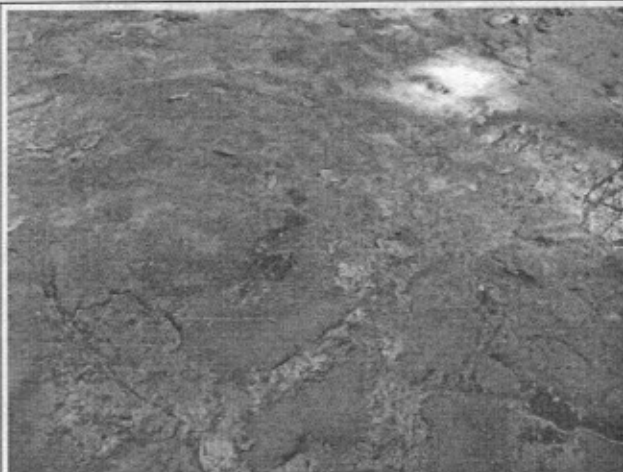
Vista de substância oleosa ao lado do dissipador.
